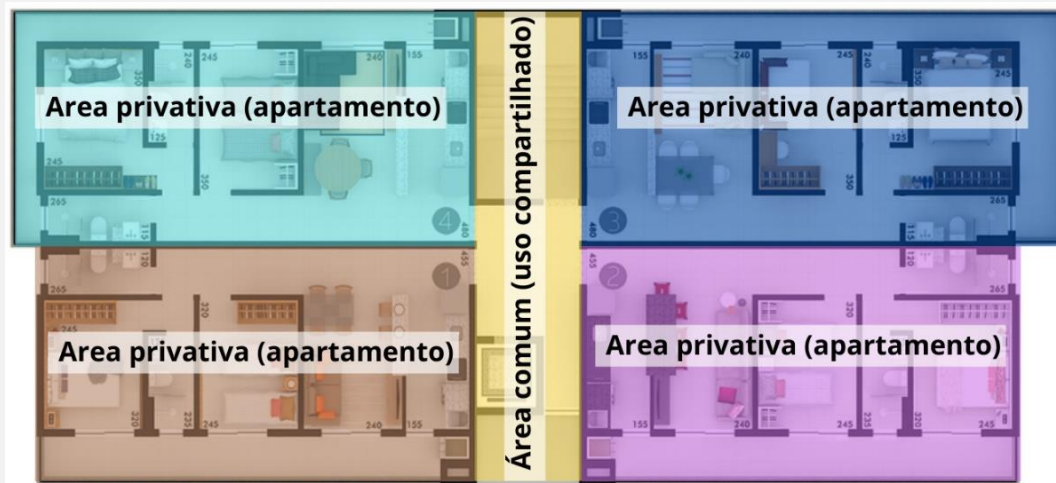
Aplicação, em planta, dos conceitos de áreas.
